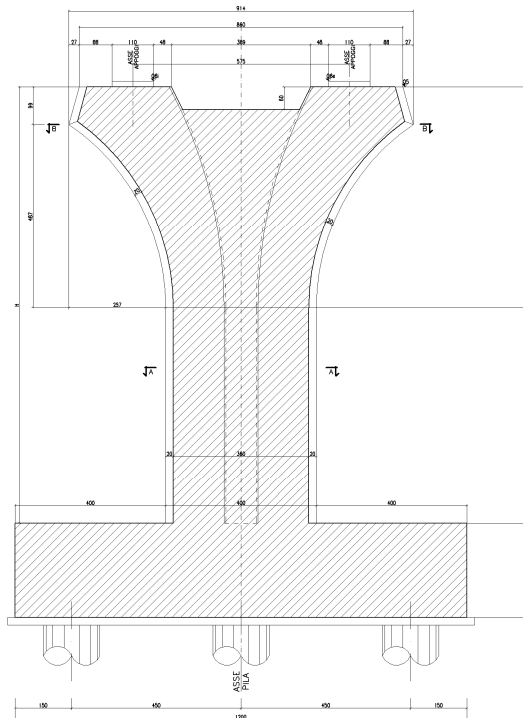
Sezione trasversale con fondazione tipo C.
